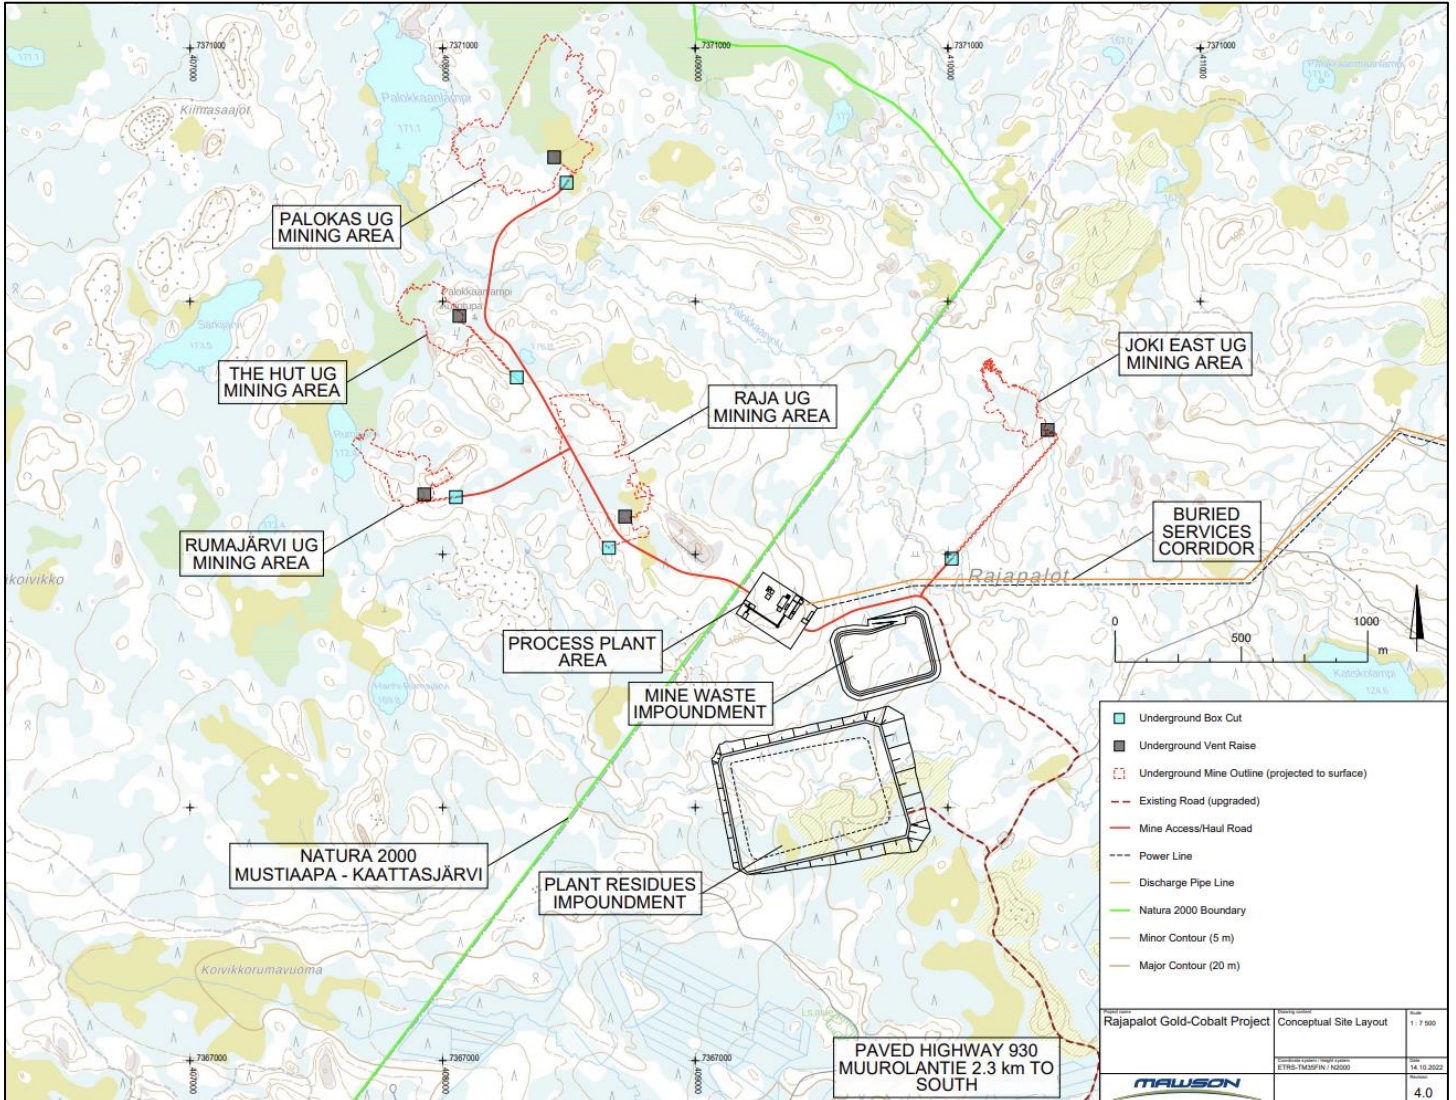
Grundriss der Rajapalot-Vorkommen und Lageplan
